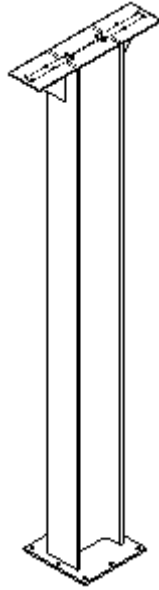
Pilar metàl·lic perfil HEB450 pel centre del forjat. (Font: "Revit")
